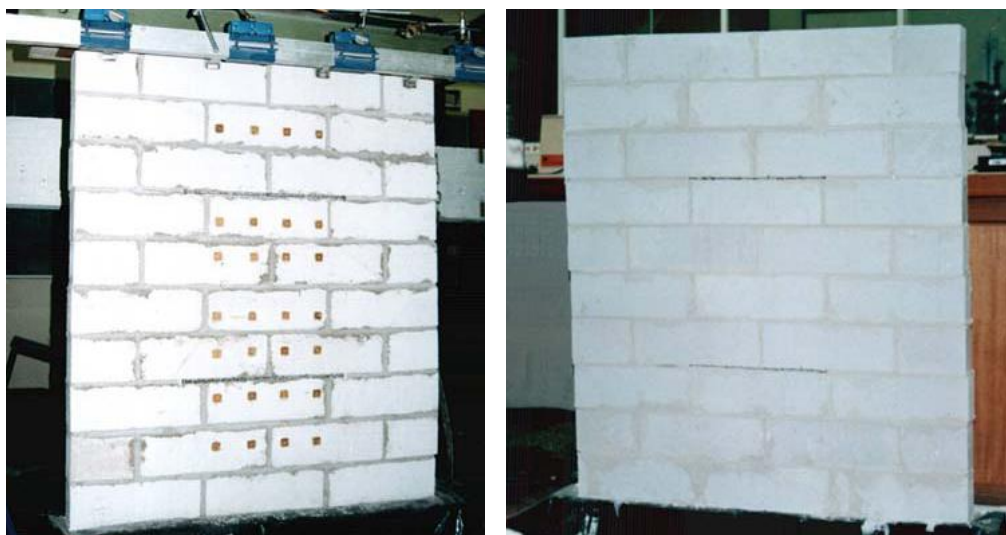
Pontos de referência e ranhuras efectuadas nas paredes de ensaio [12]
